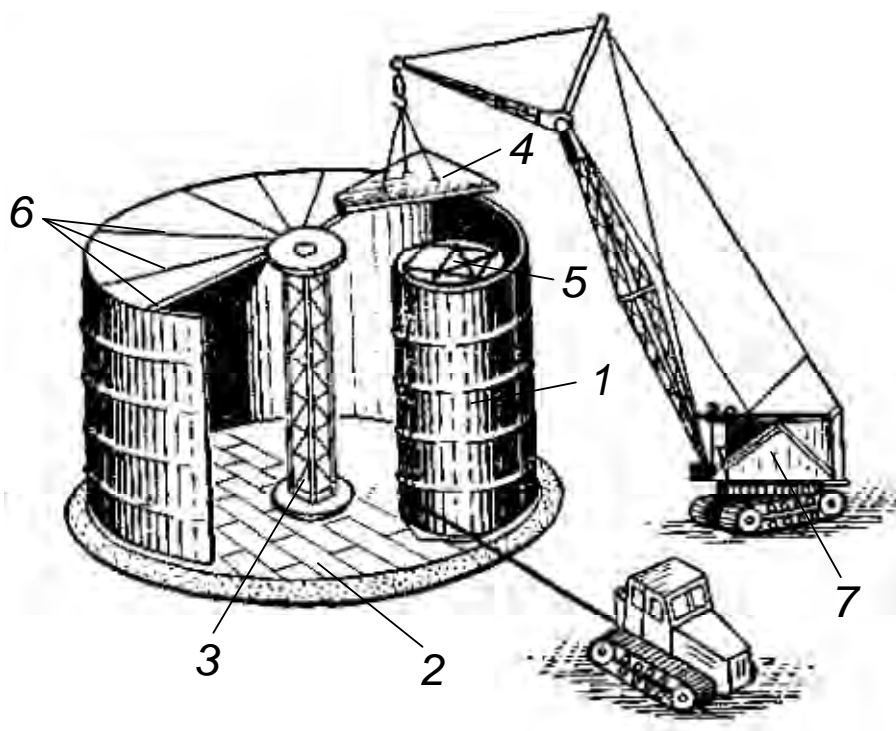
Последовательность монтажа рулонного резервуара со щитовой кровлей: 1 – рулонированный корпус резервуара; 2 – днище резервуара; 3 – центральная стойка; 4 – сегмент щитовой кровли; 5 – ферма для сохранения формы рулона; 6 – опорные балки кровли; 7 – монтажный кран
